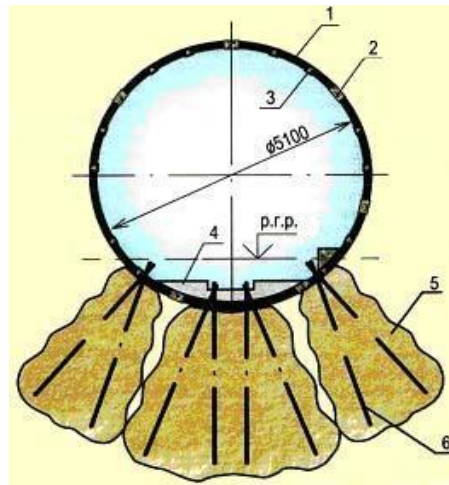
Закріплення ґрунтів ін'єкцією під час будівництва підземних споруд, а саме закріплення слабких ґрунтів основи тунелю Мінського метрополітену [82]: 1 – залізобетонна збірна обробка; 2, 3, 4 – монолітні залізобетонні конструкції, що забезпечують подовжню жорсткість; 5 – закріплений ґрунт; 6 – бурова свердловина
